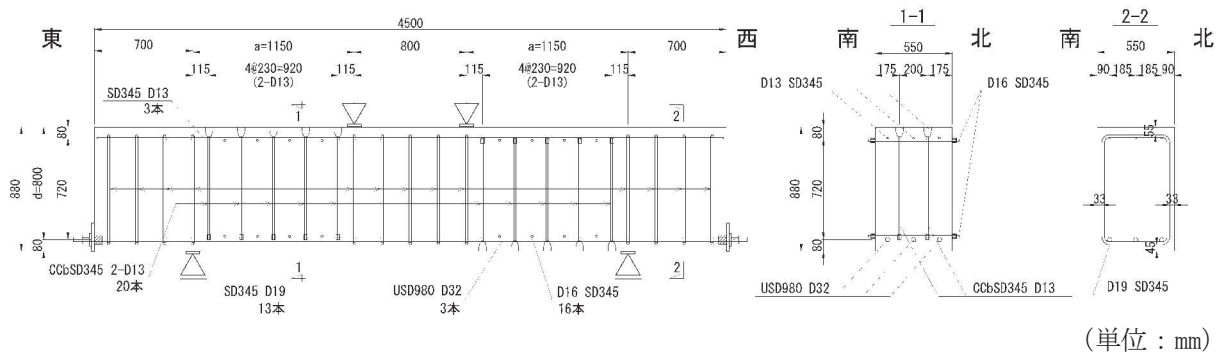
試験体概要 (CASE1 : No. 1 試験体)
